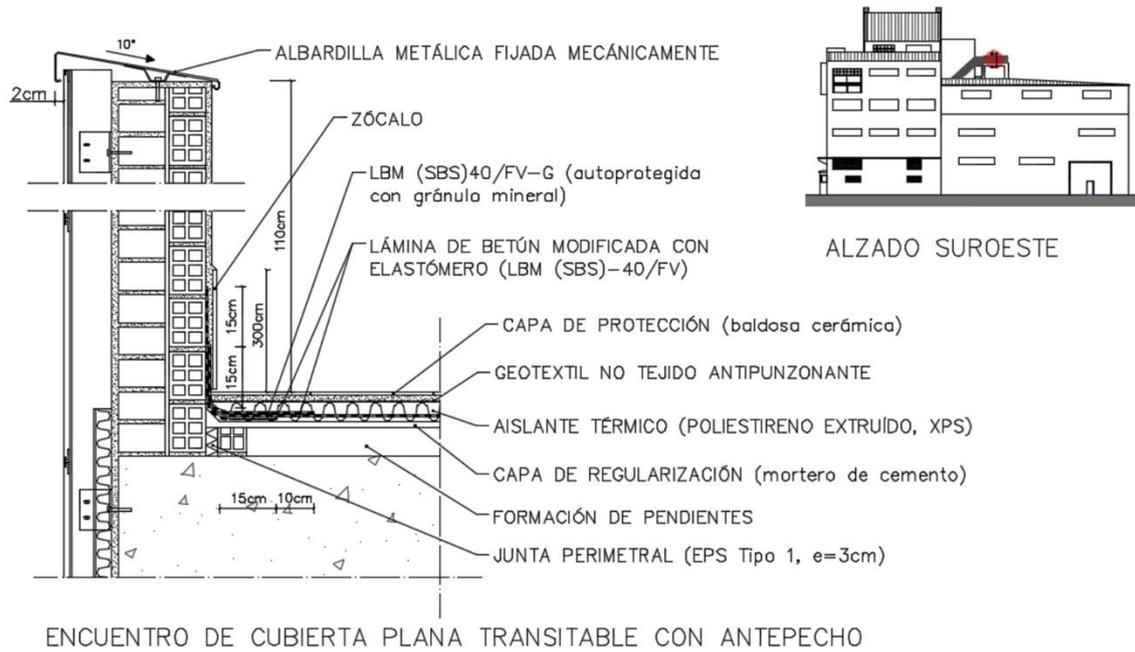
Detalle del encuentro de cubierta invertida plana transitable con el antepecho perimetral.
